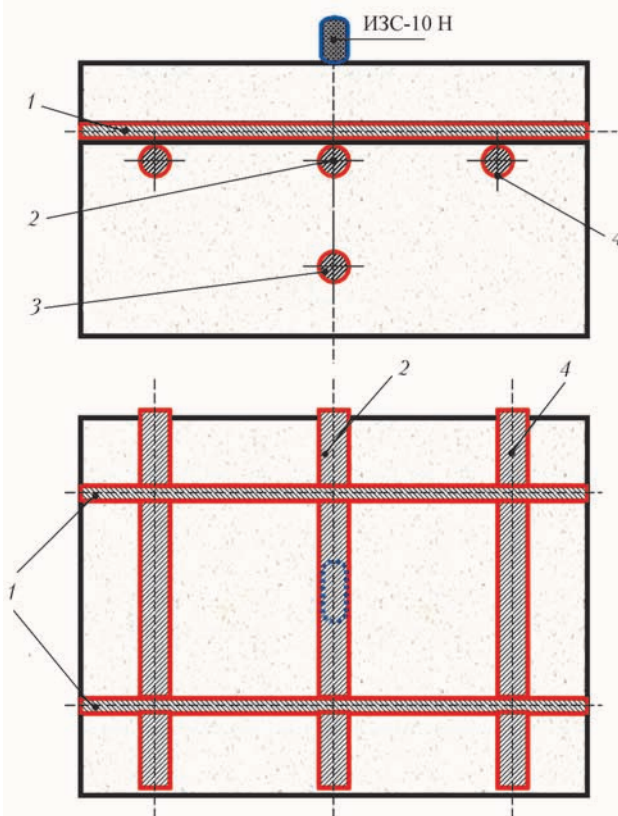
Визначення характеристик армування залізобетону для схеми перехресного армування конструкції: 1 – поперечний стрижень арматури; 2 – поздовжній арматурний стрижень, для якого визначають товщину захисного шару бетону; 3 – поздовжній арматурний стрижень другого ряду арматури; 4 – сусідні поздовжні стрижні арматури першого ряду арматури
